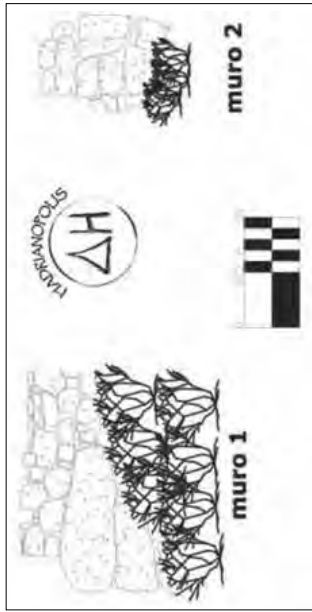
Spile, prospetto dei due stipiti all'ingresso del Santuario.
